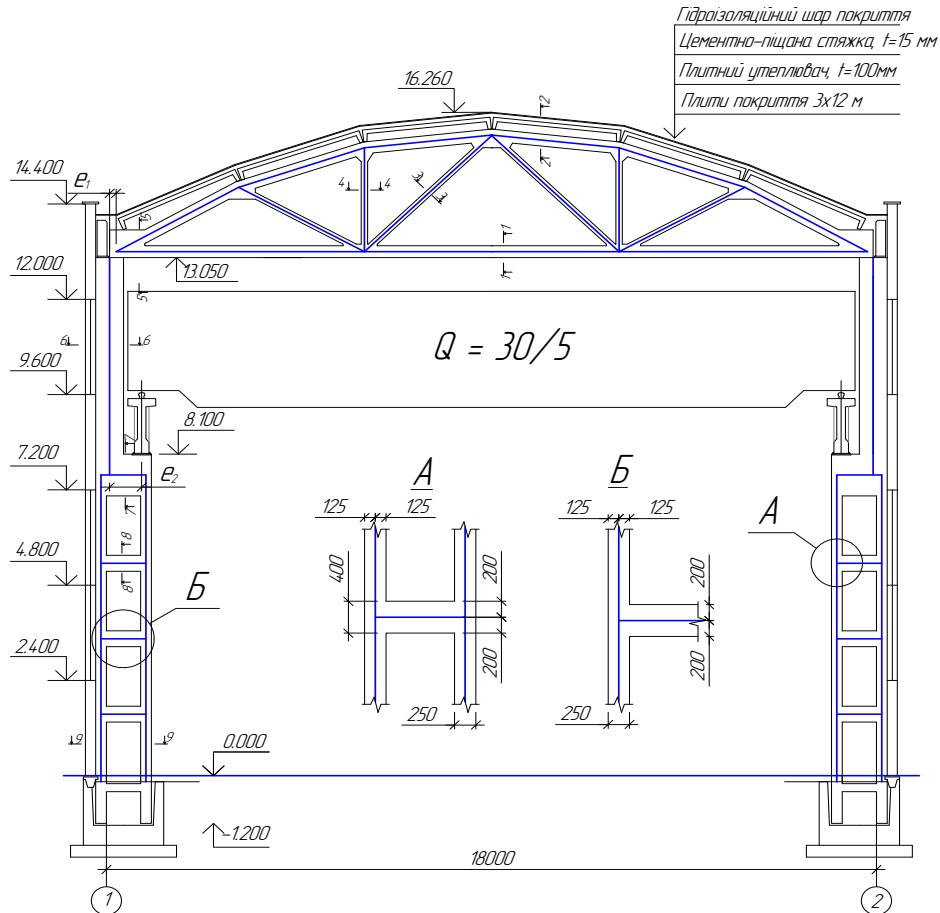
Поперечний переріз будівлі з сумщеною схемою несучого каркасу будівлі
